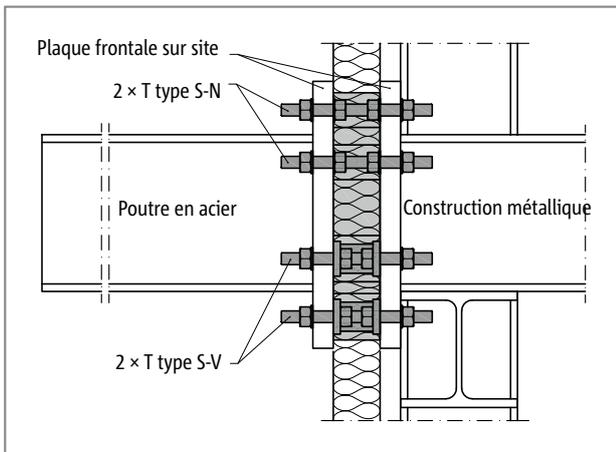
Schöck Isokorb® T type S-N et T type S-V : construction en acier en porte-à-faux libre
